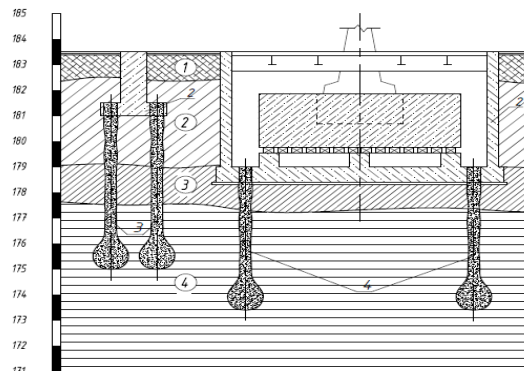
Инженерно-геологический разрез: 1 – фундамент каркаса здания; 2 – фундамент кузнечного молота; 3 – буровнеэкссионные сваи-ЭРТ усиления основания фундаментов каркаса; 4 – буровнеэкссионные сваи – ЭРТ усиления основания фундаментов кузнечных молотов; «1» – насыпной слой; «2» – суглиной тугопластичный; «3» – суглинок мягкопластичный; «4» – глина алевролитовая тугопластичная.
